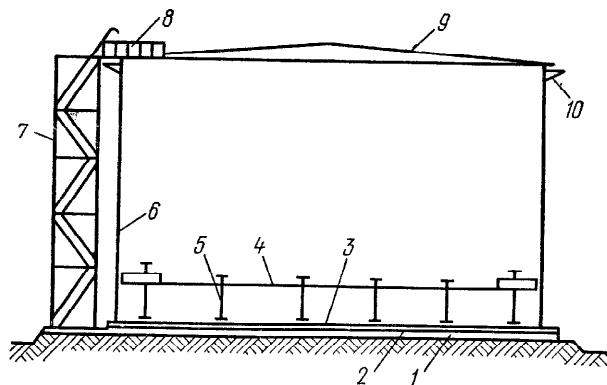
Вертикальный цилиндрический резервуар с конической крышей:
